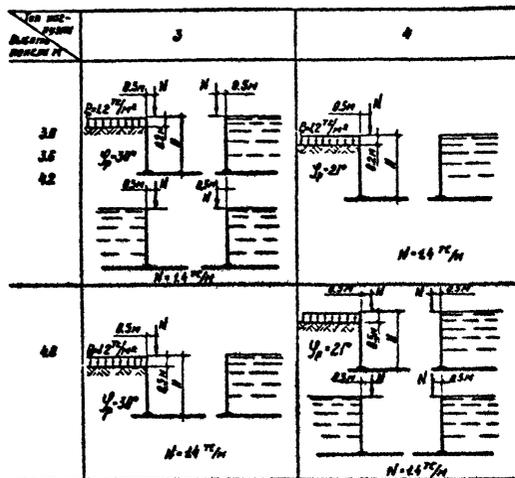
Схемы расчетных нагрузок на консольные стены высотой 3,0 + 4,8 м.
